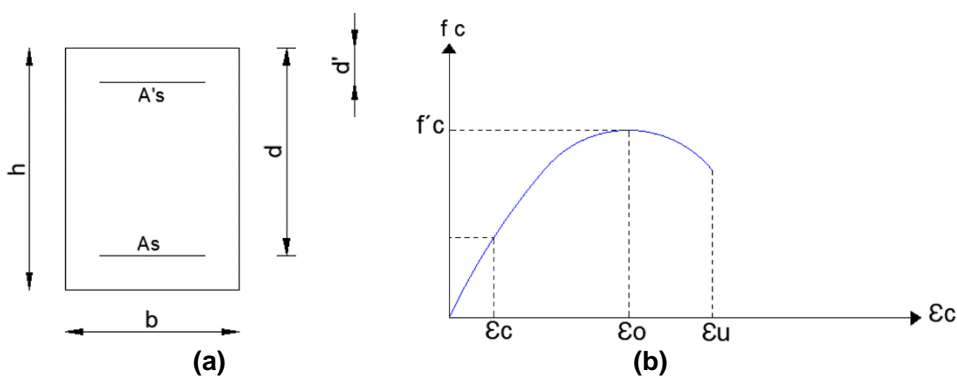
a) Sección transversal de una viga doblemente armada y nomenclatura; b) Deformación del hormigón ϵ_c , para vigas bien diseñadas este punto se encuentra debajo de la deformación ϵ_o
